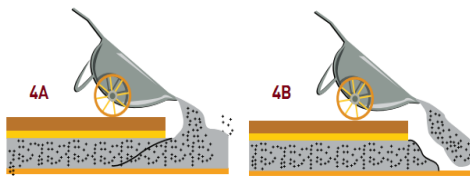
Vaciado del concreto en losas (UNACEM, 2014).
